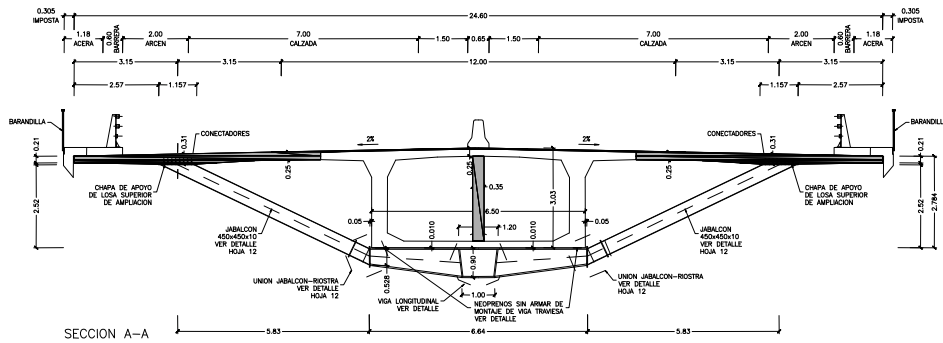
Sección transversal del Puente de Los Santos ampliado
